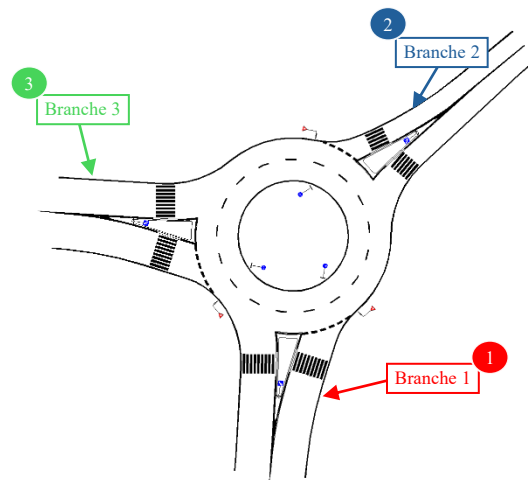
Vue en plan sur le deuxième carrefour
